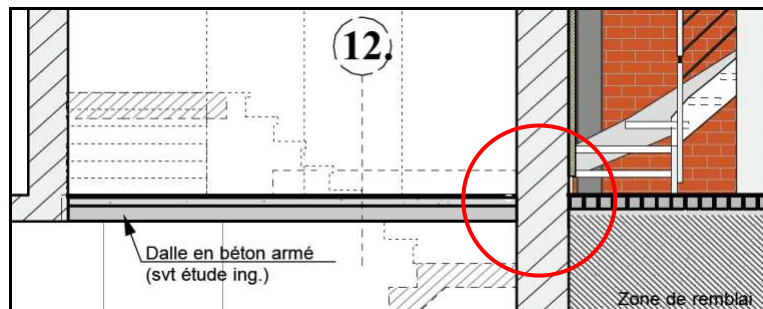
Détail d'une coupe du bâtiment – illustration du NC : jonction du mur extérieur et du plancher
